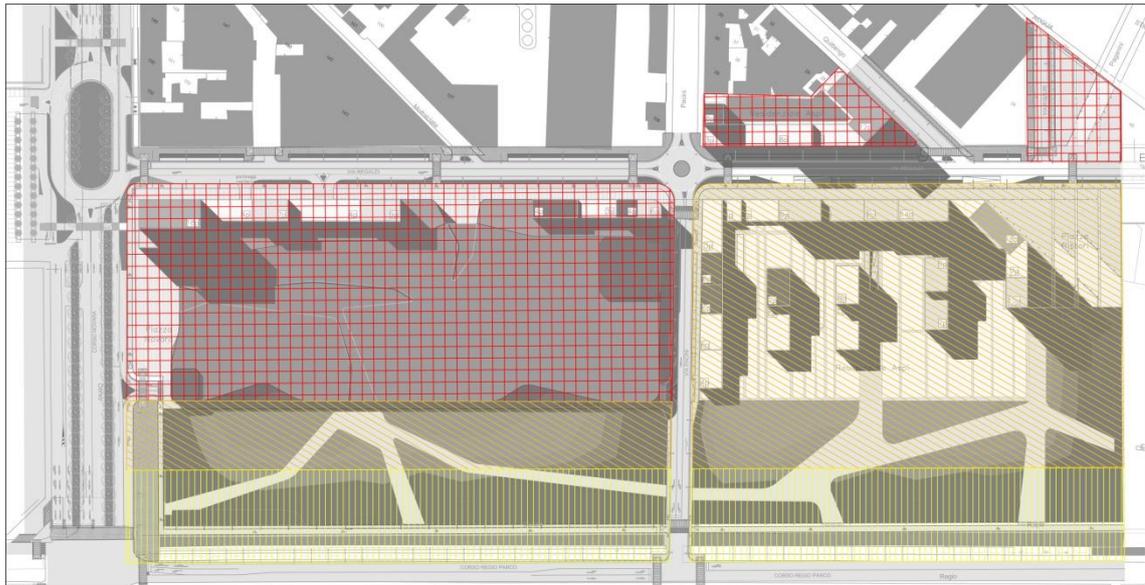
Planimetria del programma di interventi con indicazione delle classi di destinazione acustica del territorio proposte nella seconda ipotesi.
